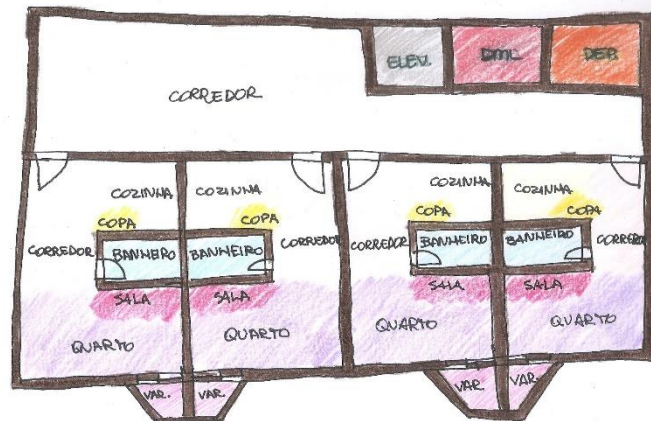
Croqui do pavimento tipo da edificação do Serrano Apart-Hotel
